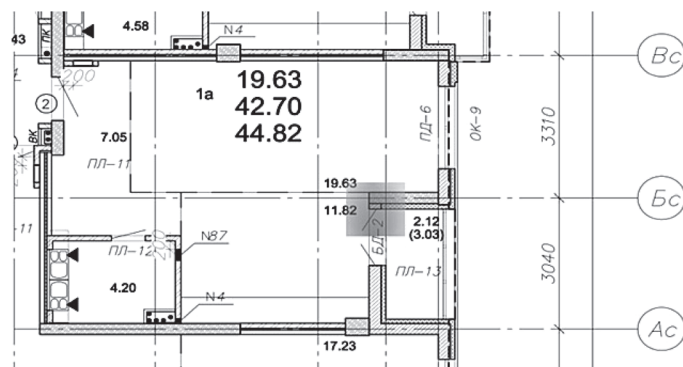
Фрагмент плана здания с указанием рассчитываемого узла сопряжения (выделено серым прямоугольником)
